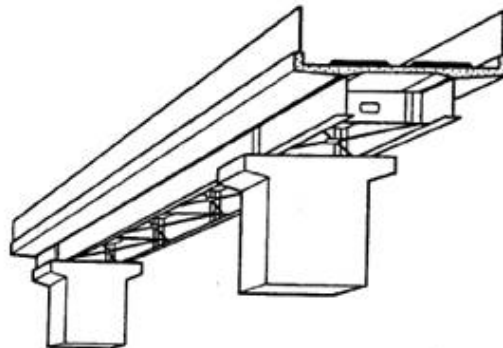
Kokaigawa Bridge-소수주형 합성거더교(Japan)
